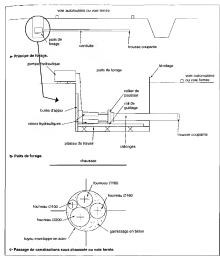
• Fouilles en galerie par forage horizontal.
